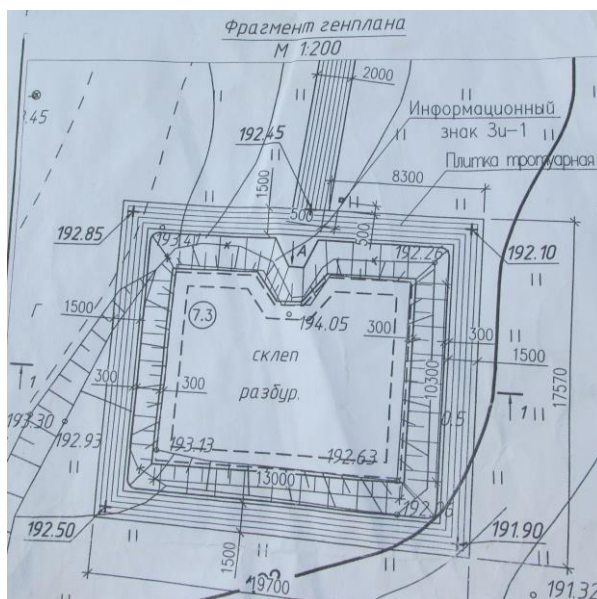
Фундаменты усадебного дома («склепа») на генеральном плане
